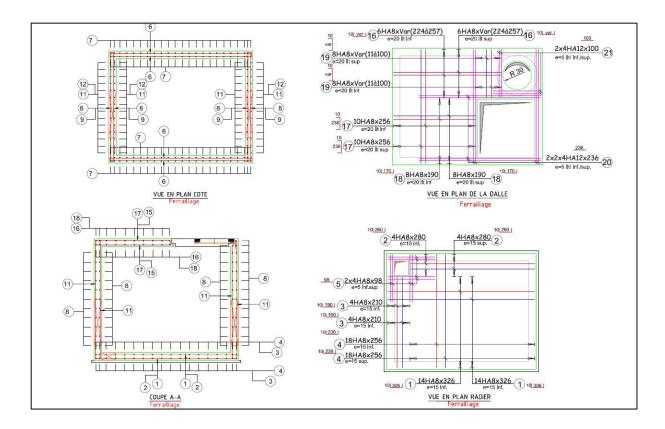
Exemple de plan d'exécution de regards de ventouse (Plan de ferraillage)
